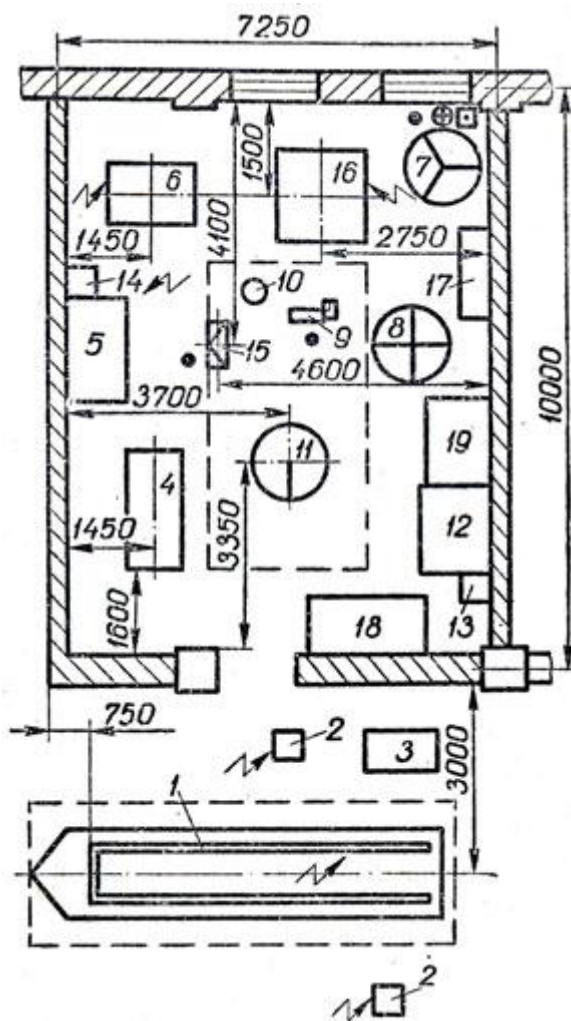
Планировка поста смены колес и шиномонтажного цеха: 1 - подъемник для вывешивания автомобиля при снятии и установке колес; 2 - электрогай-козерты; 3 - тележка для транспортирования колес; 4 - установка для мойки колес; 5 - стеллаж; 6 - стенд для демонтажа и монтажа шин; 7 - ванна для испытания камер; 8 - вешалка для камер; 9 - борторасширитель; 10 - переносная лампа; 11 - стол для подготовки шин к монтажу; 12 - верстак; 13 - ларь для обтирочного материала; 14 - пылесос; 15 - установка для накачивания шин; 16 - стенд для очистки дисков; 17 - стеллаж для дисков; 18 - стеллаж для колес; 19 - стеллаж для покрышек
